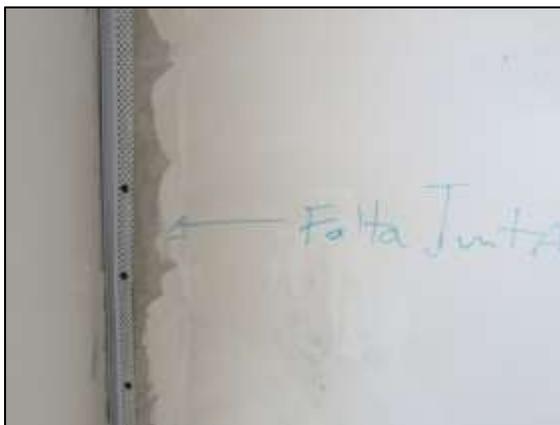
Revisión de colocación de juntas en la intersección de Durock con pared de mampostería.
